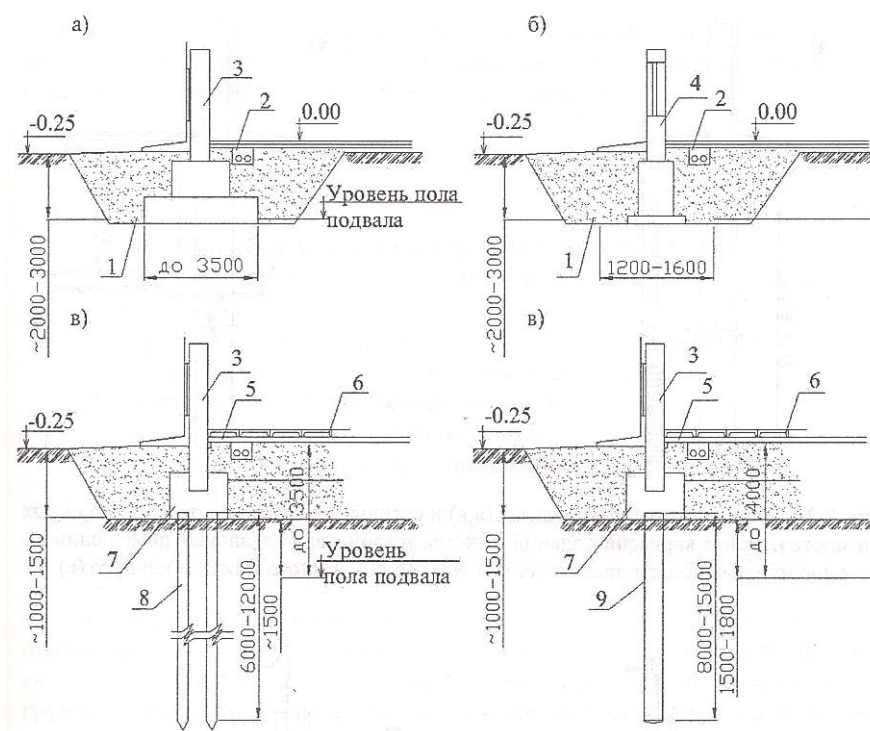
Схемы фундаментов промышленных зданий и возможная глубина устройства подвального помещения:
